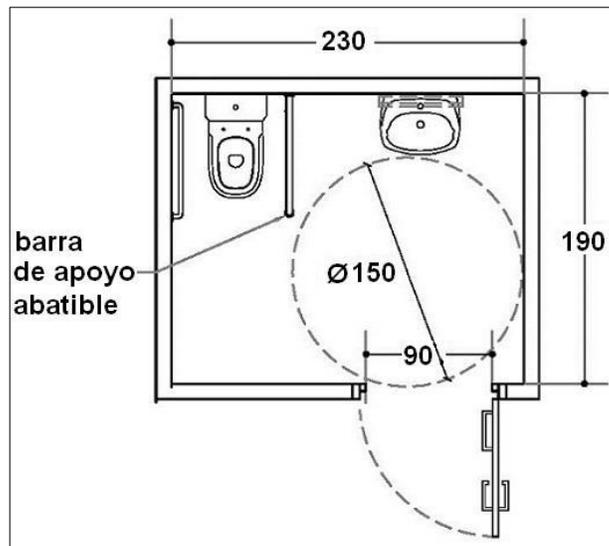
Vista en planta de un ejemplo de cubículo S.S
